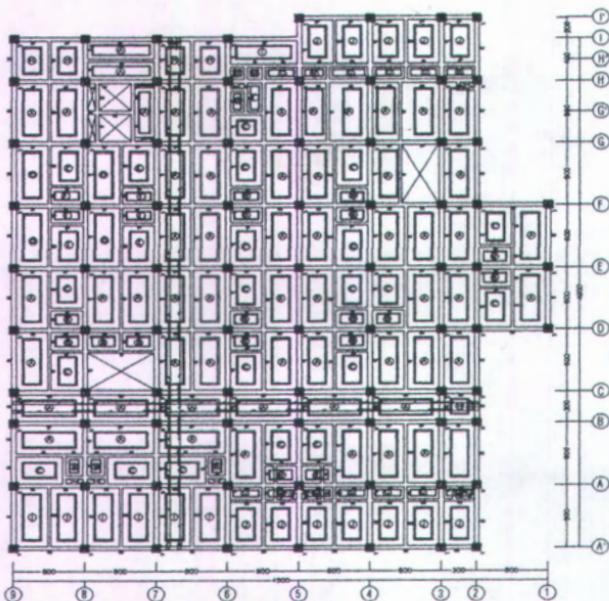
Denah Lantai 3,5,7 dan 8
